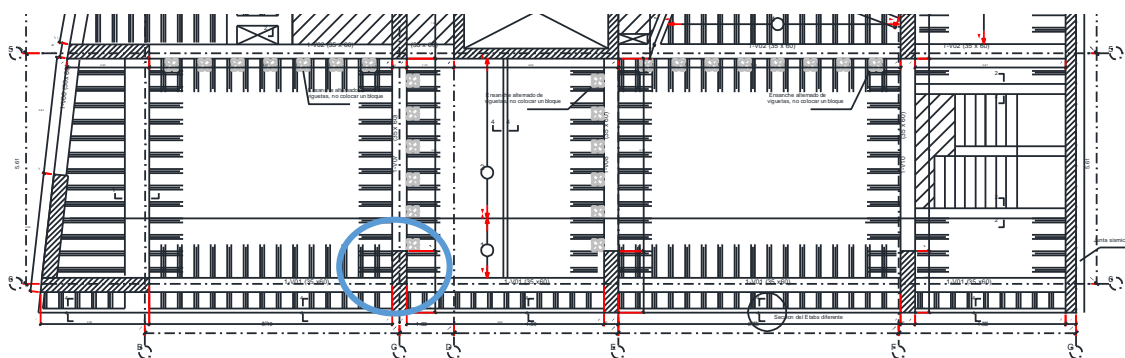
Área tributaria correspondiente a cada columna – Sistema aislado
